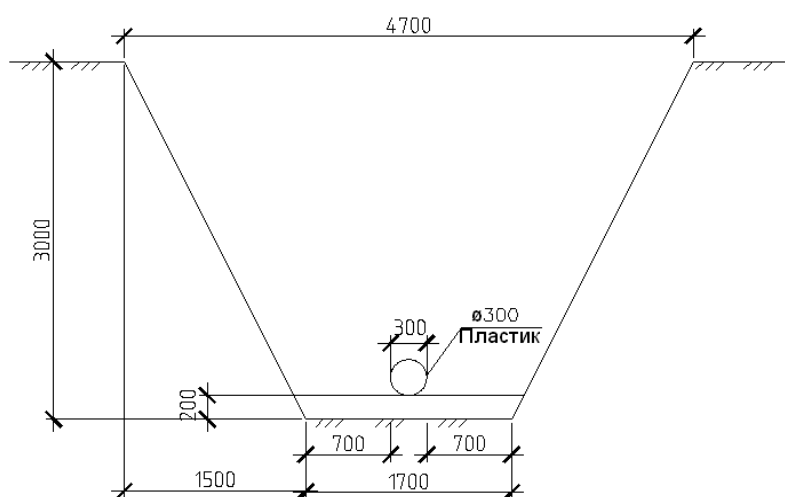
Поперечное сечение траншеи водопровода
